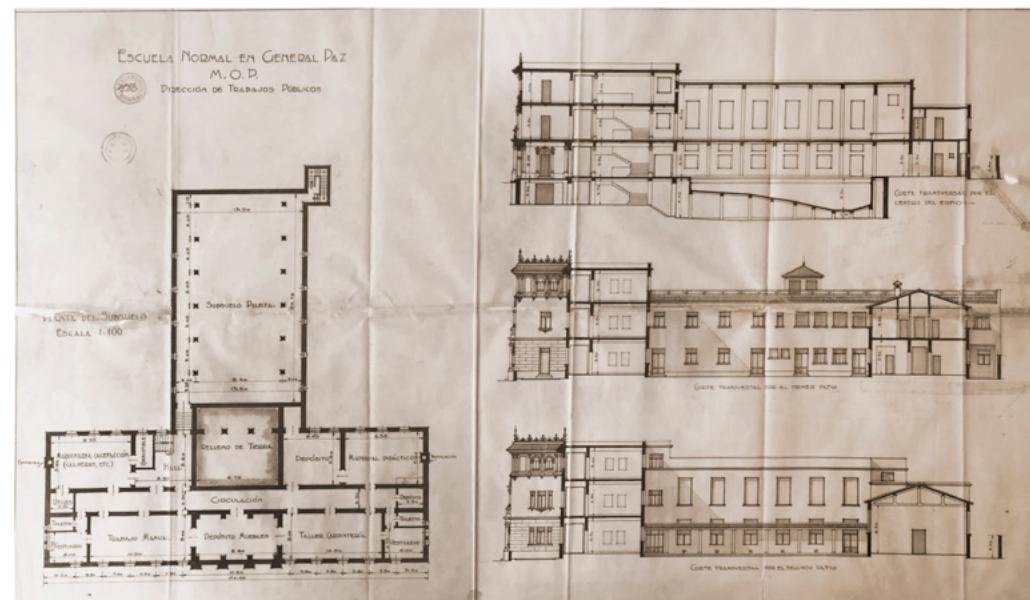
ENSC. Planta subsuelo y cortes transversales (Archivo de la Secretaría de Arquitectura de la Provincia de Córdoba).
